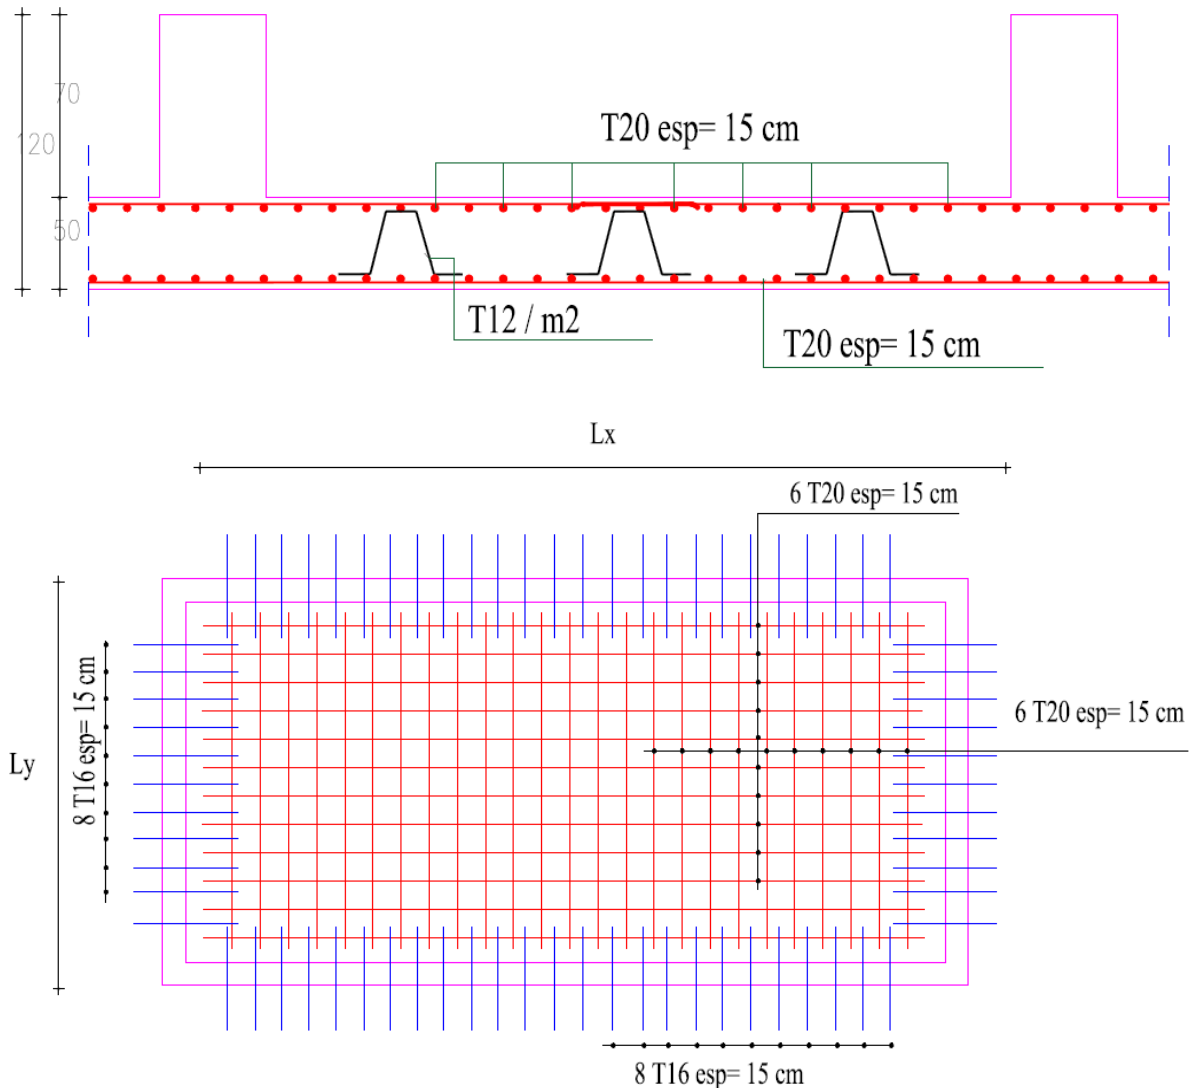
Schémas de ferrailage de la dalle du radier.
